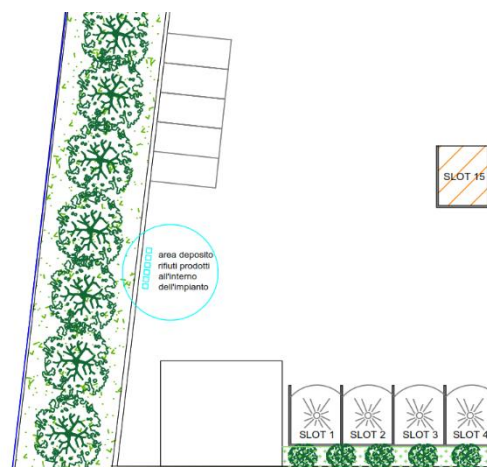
Layout area deposito codici EER prodotti dall'impianto
